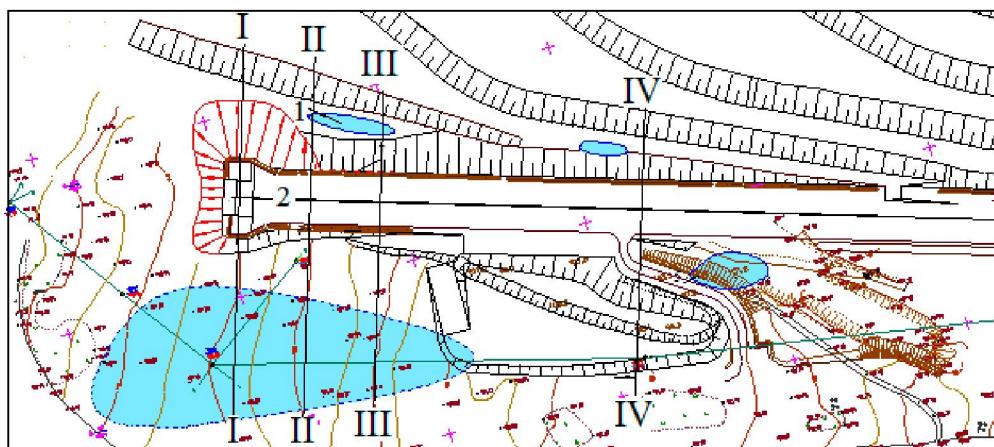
План строительства насыпи ЦПТ [1]: 1 – водоем под оползнем;
